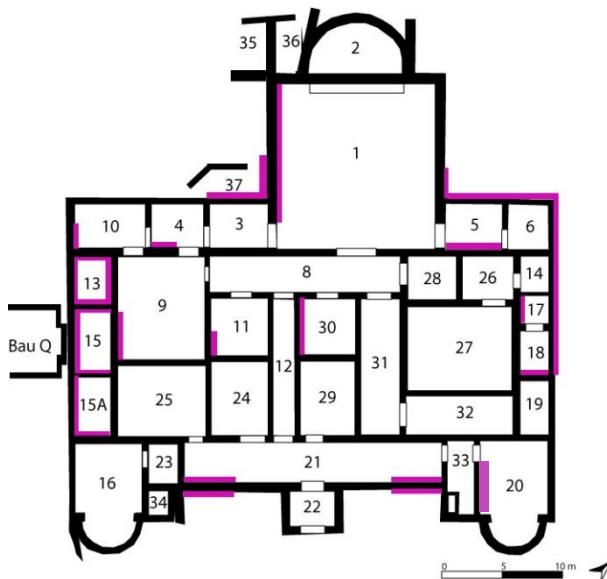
Grundrissplan, lila markiert sind jene Innen- und Außenmauern mit einem ausgeprägten biogenen Bewuchs.
